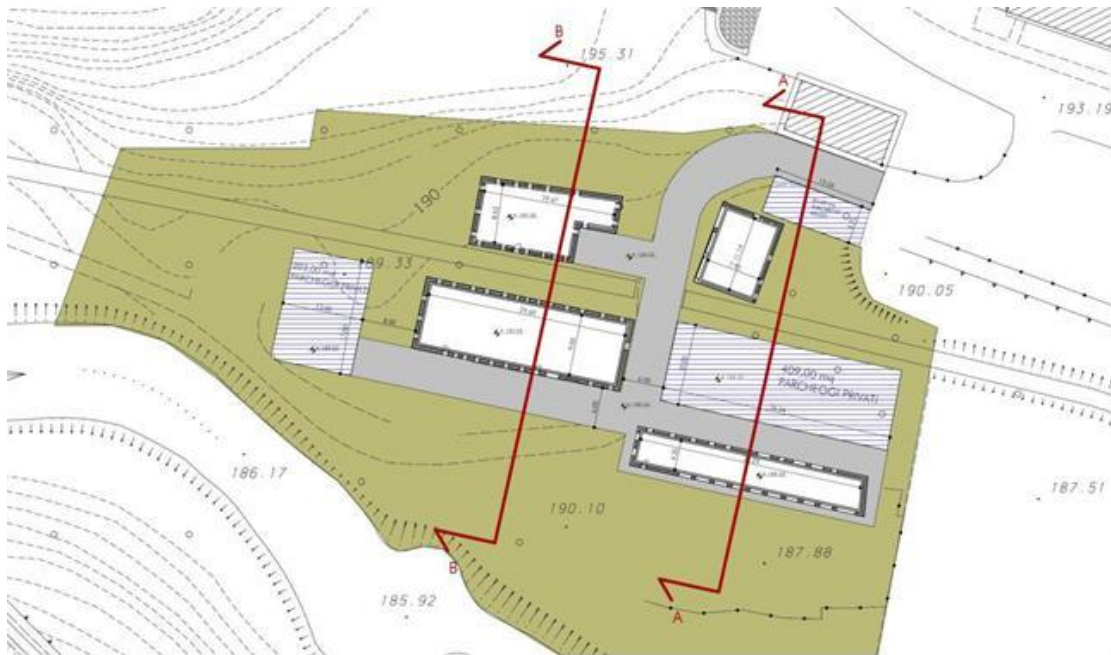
stralcio tavola 10 del piano di recupero, "Planimetria generale con individuazione dei volumi di demolizione e in decollo"
